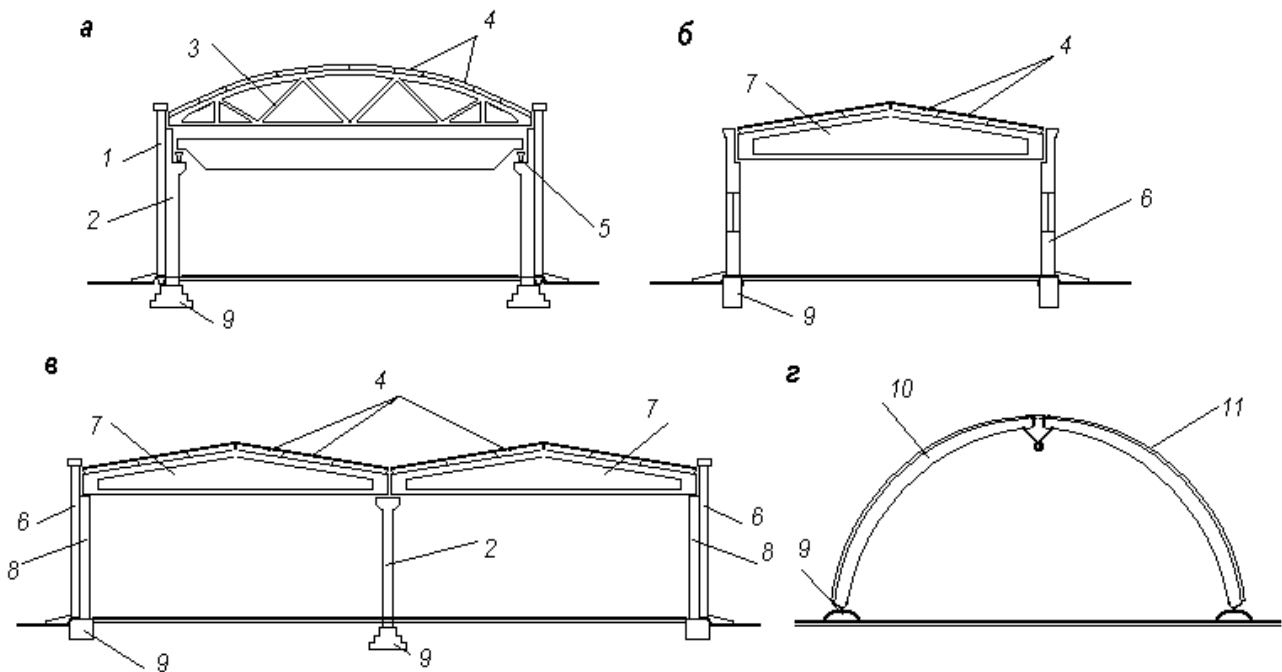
Конструктивні типи одноповерхових виробничих будівель: а – каркасний; б – безкаркасний; в – з неповним каркасом; г – шатровий; 1 – зовнішня стіна; 2 – колона; 3 – ферма; 4 – плити покриття; 5 – підкранова балка; 6 – несуча стіна; 7 – балка покриття; 8 – пілястра; 9 – фундамент; 10 – арка; 11 – покриття арки
